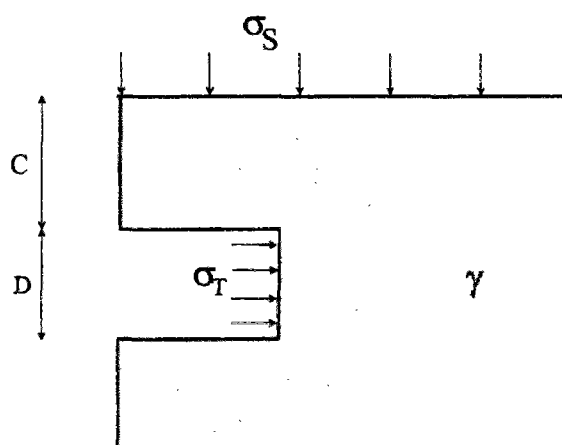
Schéma de la coupe longitudinale d'un tunnel.
